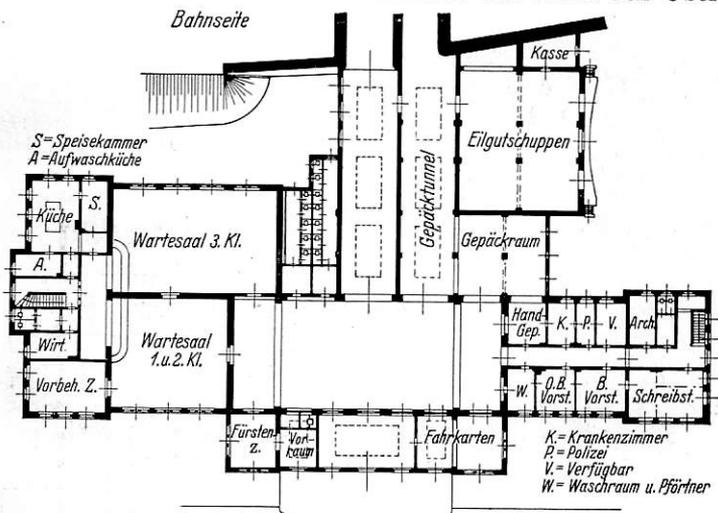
Grundriß Empfangsgebäude Gera Süd.
